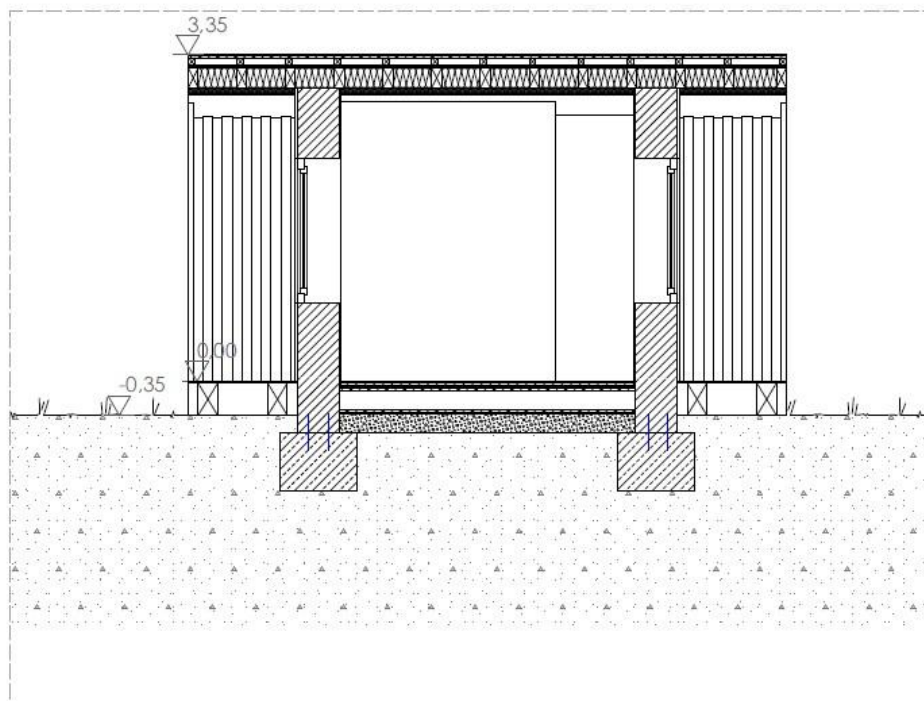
Baukonstruktiver Schnitt 02, M 1:100
